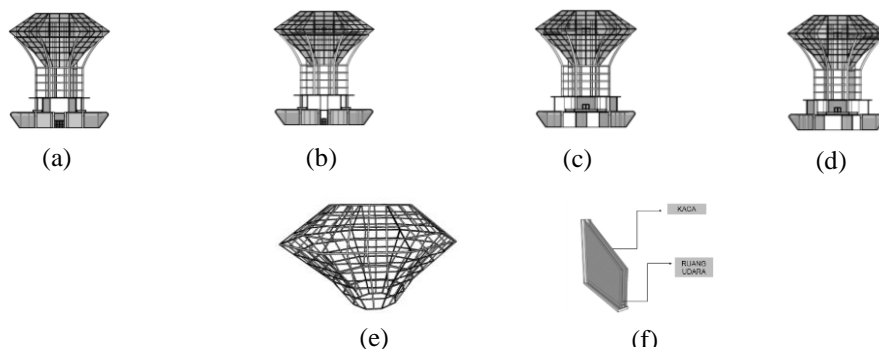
a) Tampak depan, b) Tampak belakang, c) Tampak kiri, d) Tampak kanan
